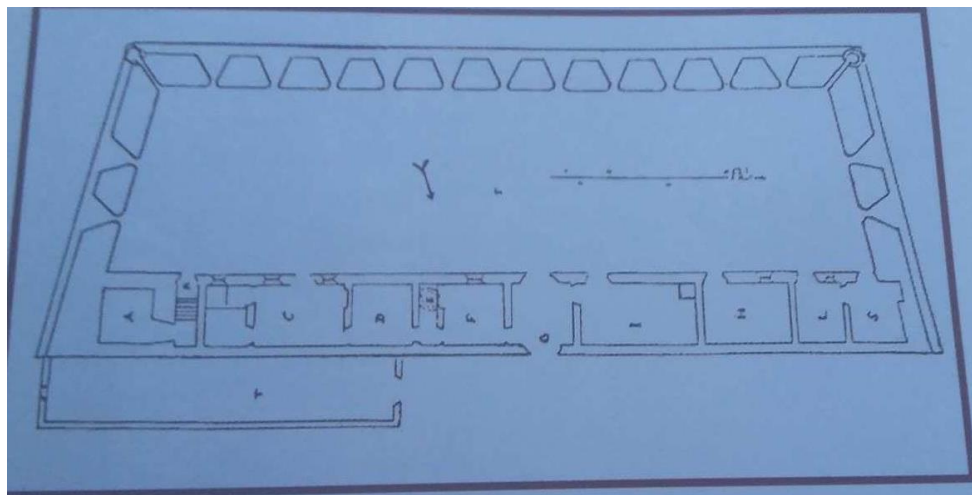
Planta do Forte de Nossa Senhora da Conceição
